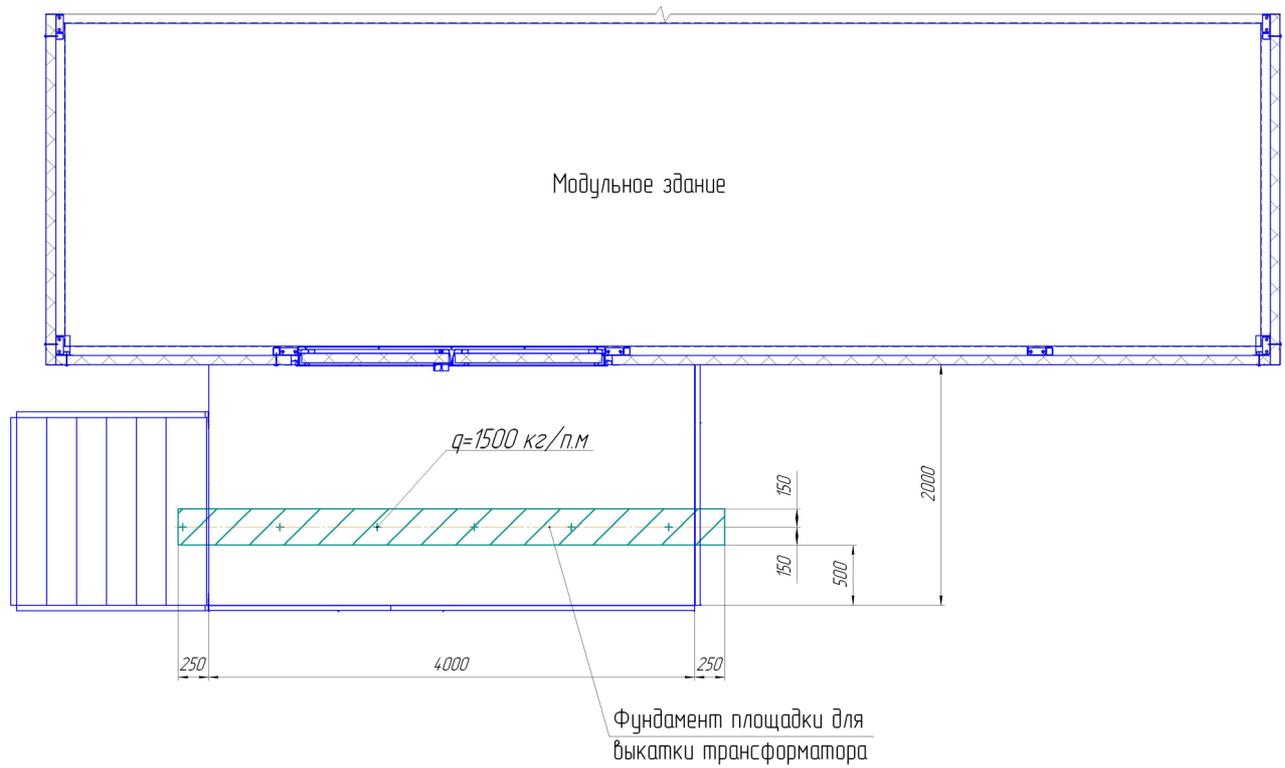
Схема плана ростверка под площадку 4000x1700
